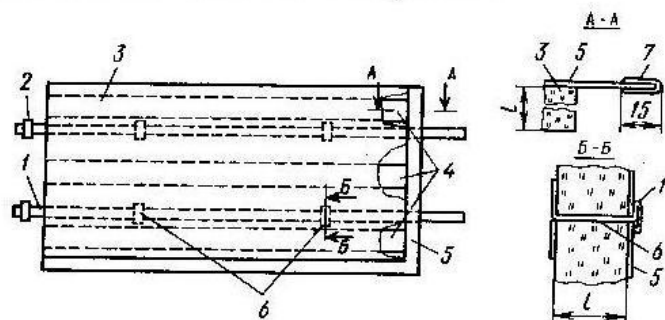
Опорный каркас для крепления металлопокрытия: 1 — лапка, 2 — асбокартон, 3 — планка, 4 — заклепка
